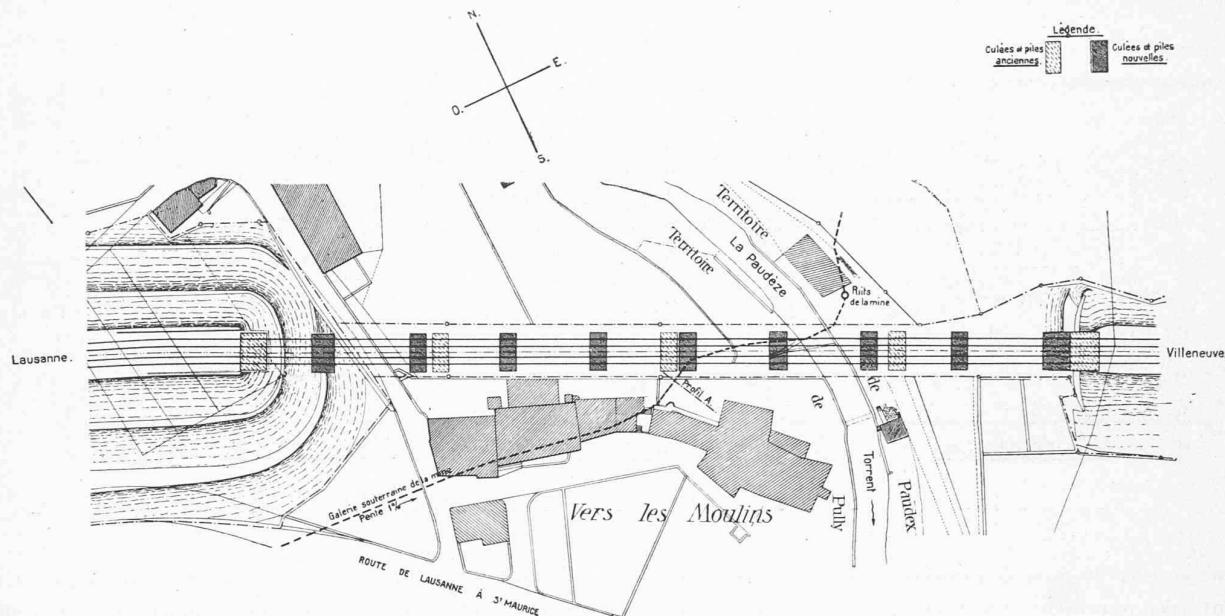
Plan de situation. — Echelle 1 : 1500.
